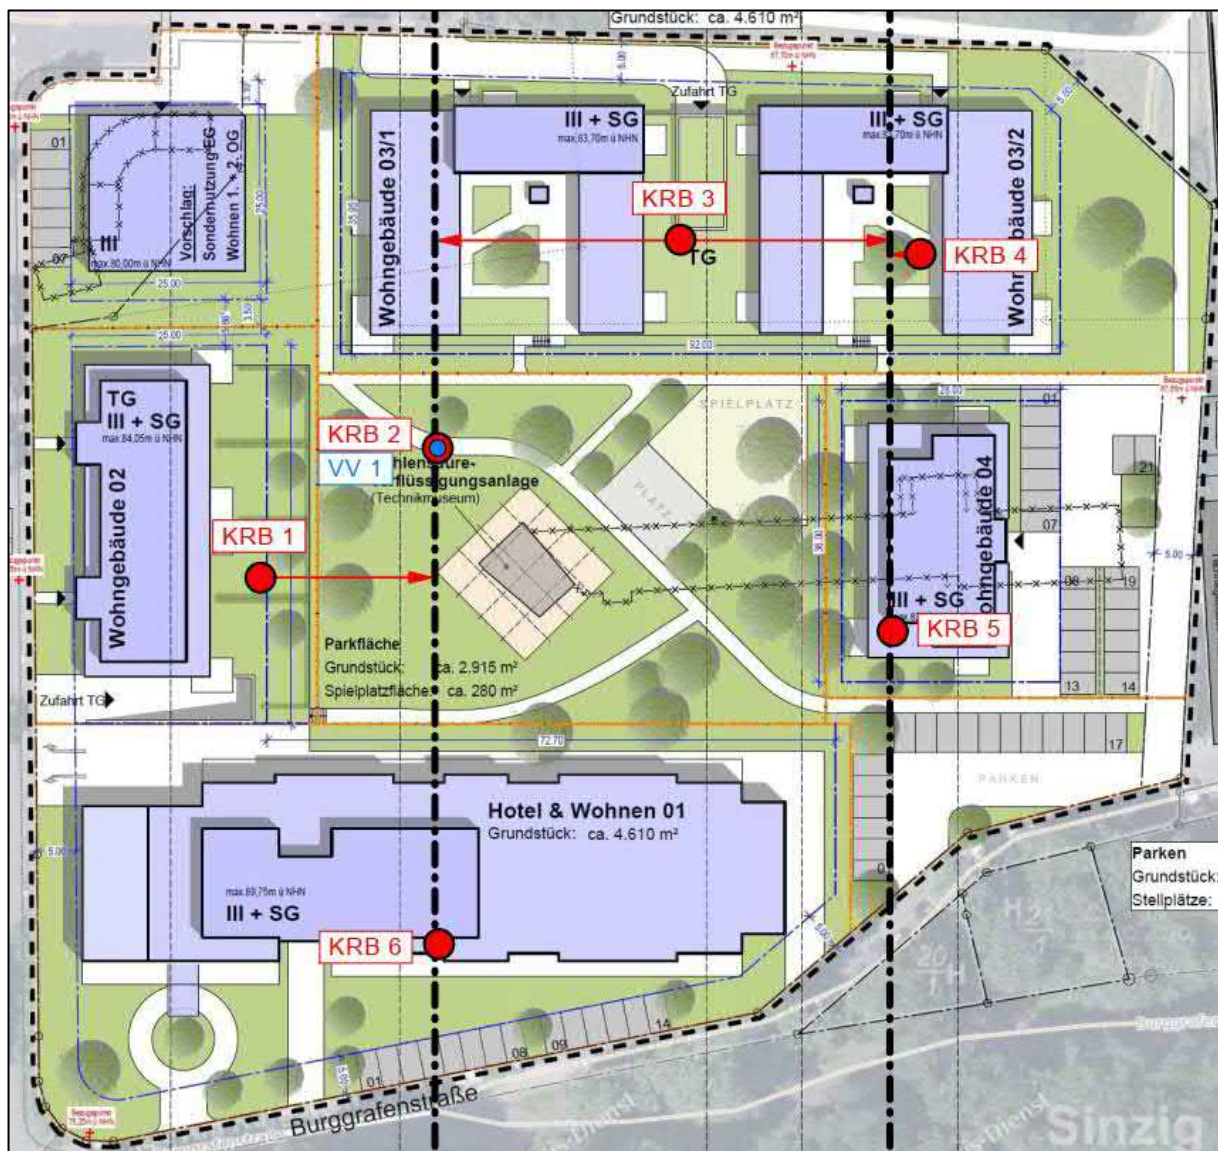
Lageplan - Standorte Kleinrammborungen
